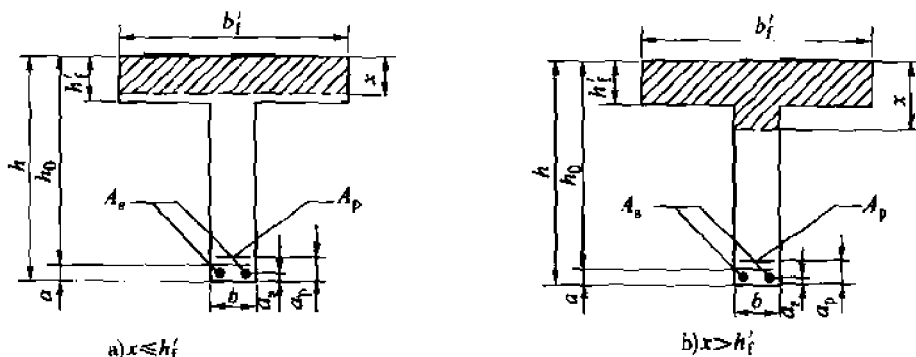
T 形截面受弯构件正截面承载力计算
